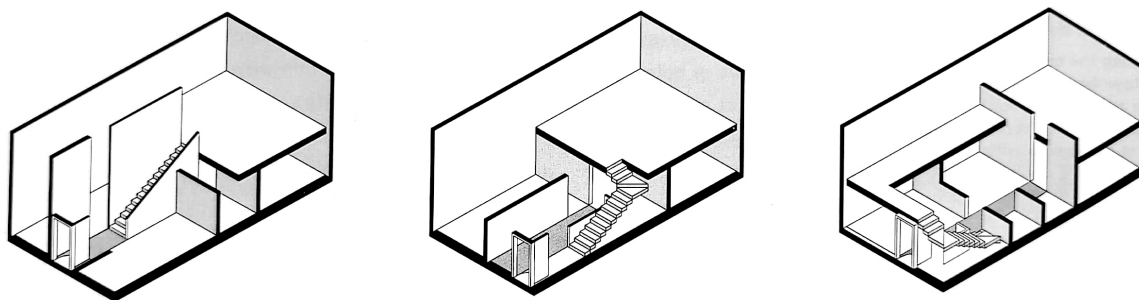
Townhouse ve formě mezonetu – Nizozemsko (Zdroj: Filip Dujardin, www.archdaily.com)
